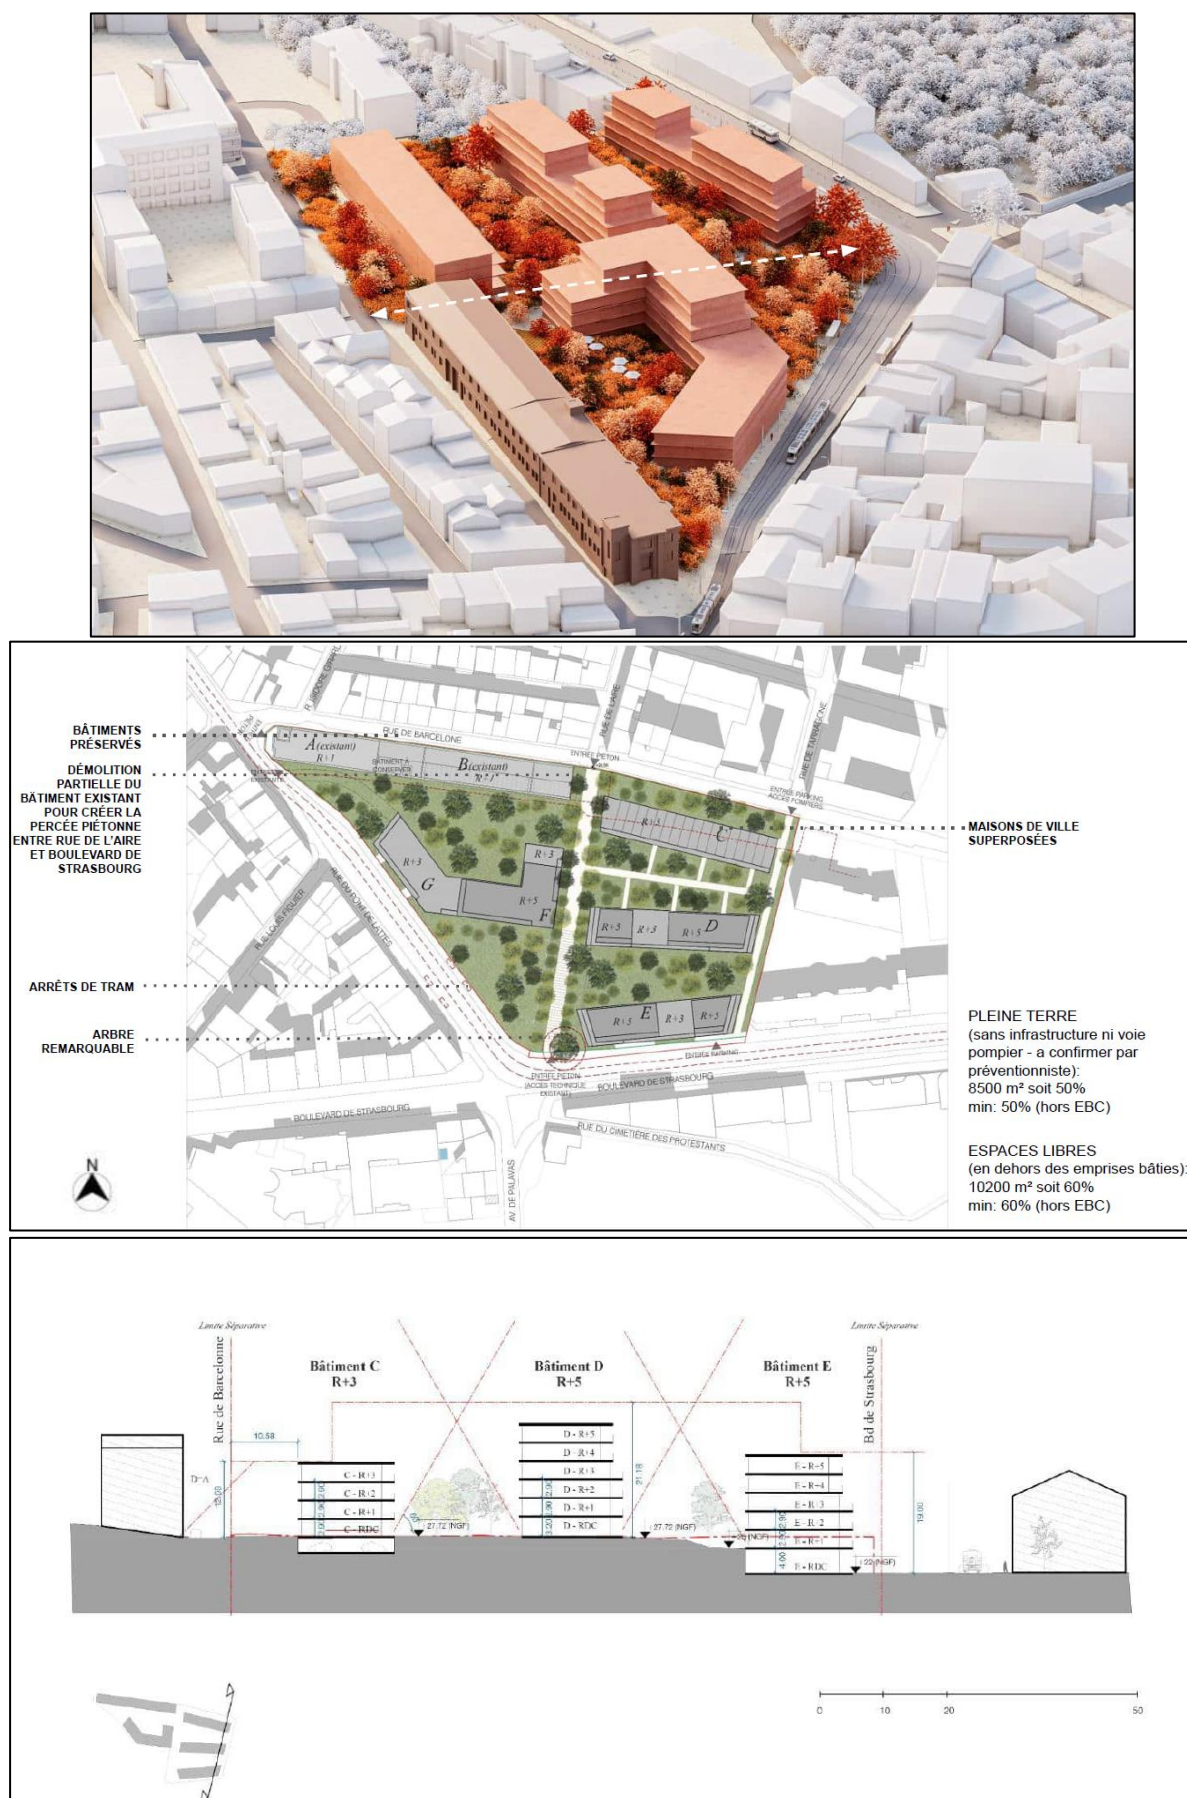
Plans et coupes du projet d'aménagement en date de juillet 2023 (source : rapport BG de 2025)
